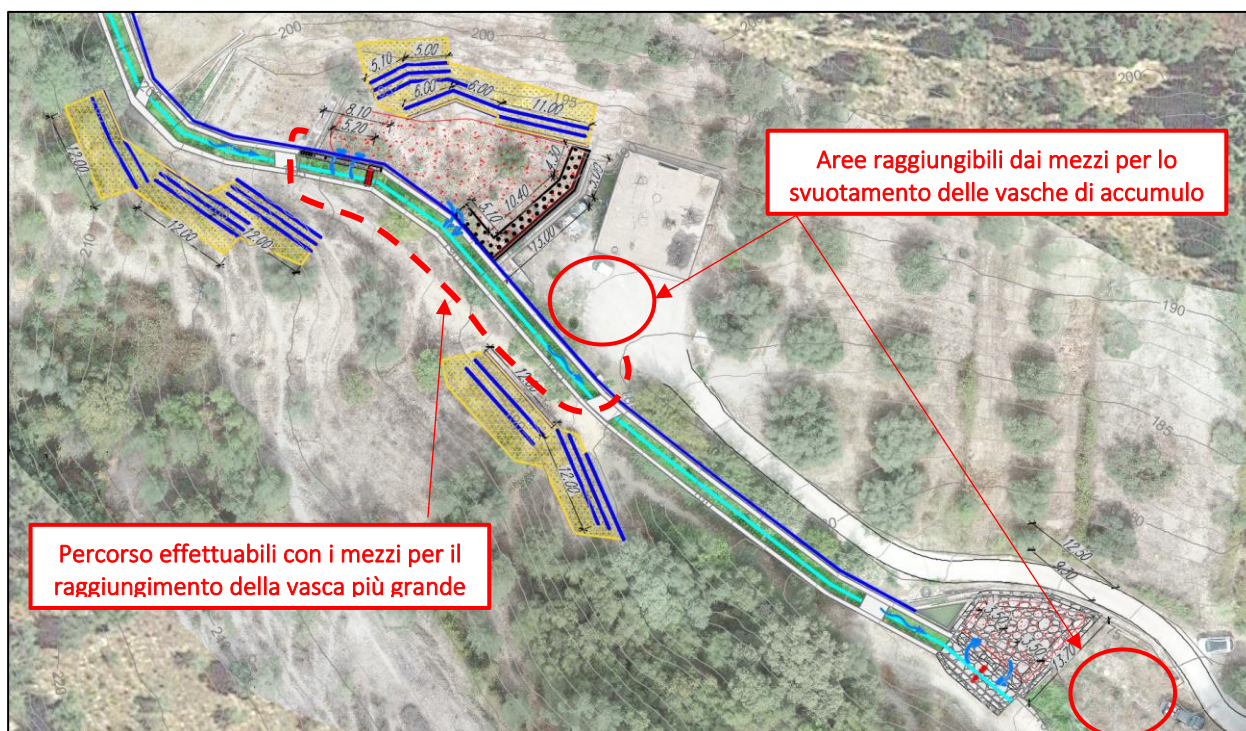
Estratto dalla planimetria di progetto - vasche di accumulo a valle sul Funtana Manna.
